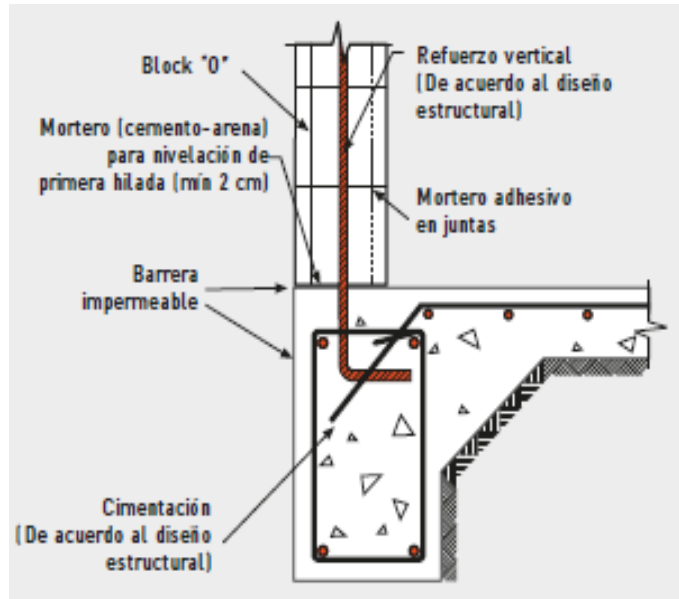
Corte de la cimentación y detalle del armado de refuerzo para el block tipo "O"
